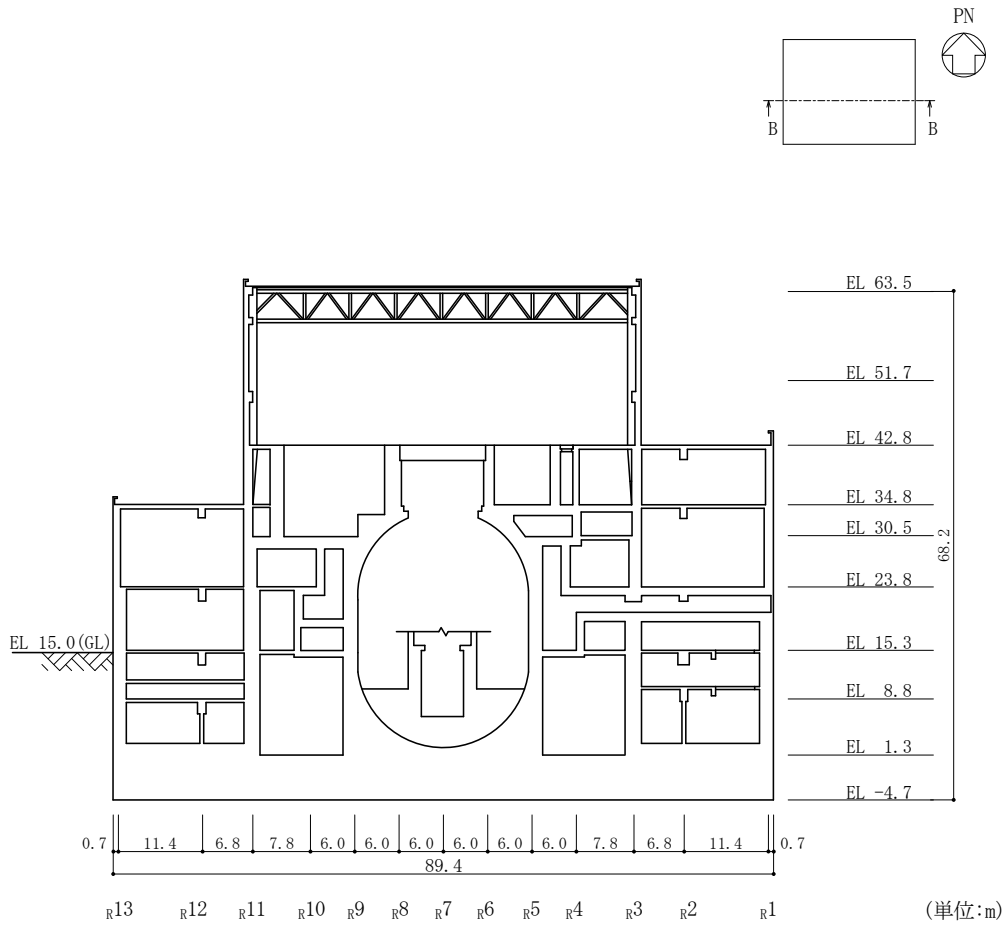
(2) 原子炉建物の概略断面図 (B-B 断面, EW 方向)
